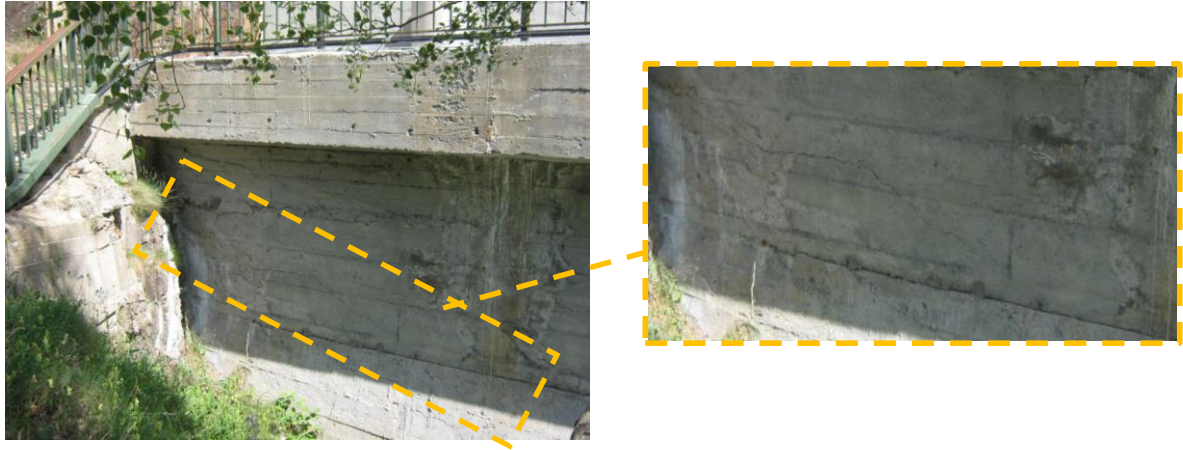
Fisura en paramento aguas abajo cerca del estribo derecho.
